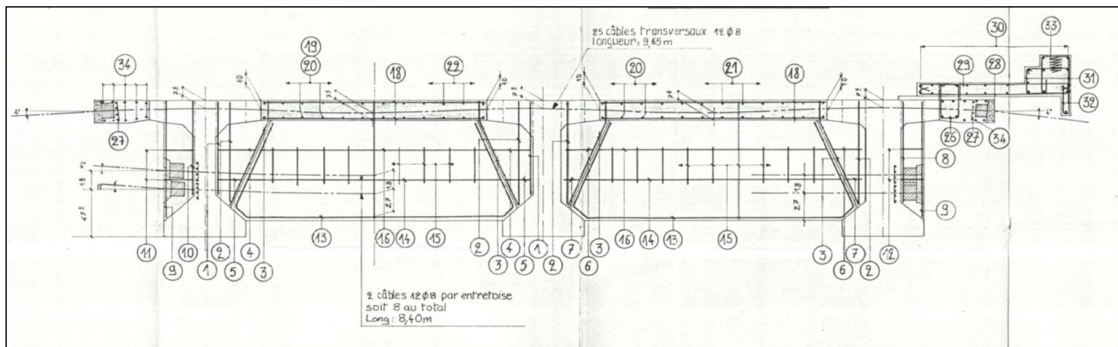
Coupe transversale d'un hourdis de VIPP avec section non ferrillée
